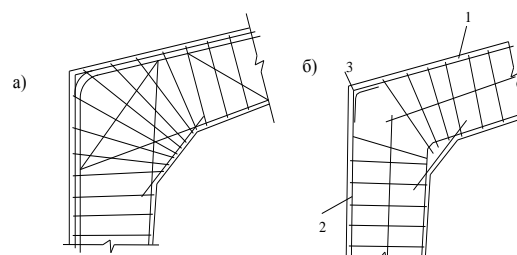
Армування вузла з'єднання ригеля зі стояком:
